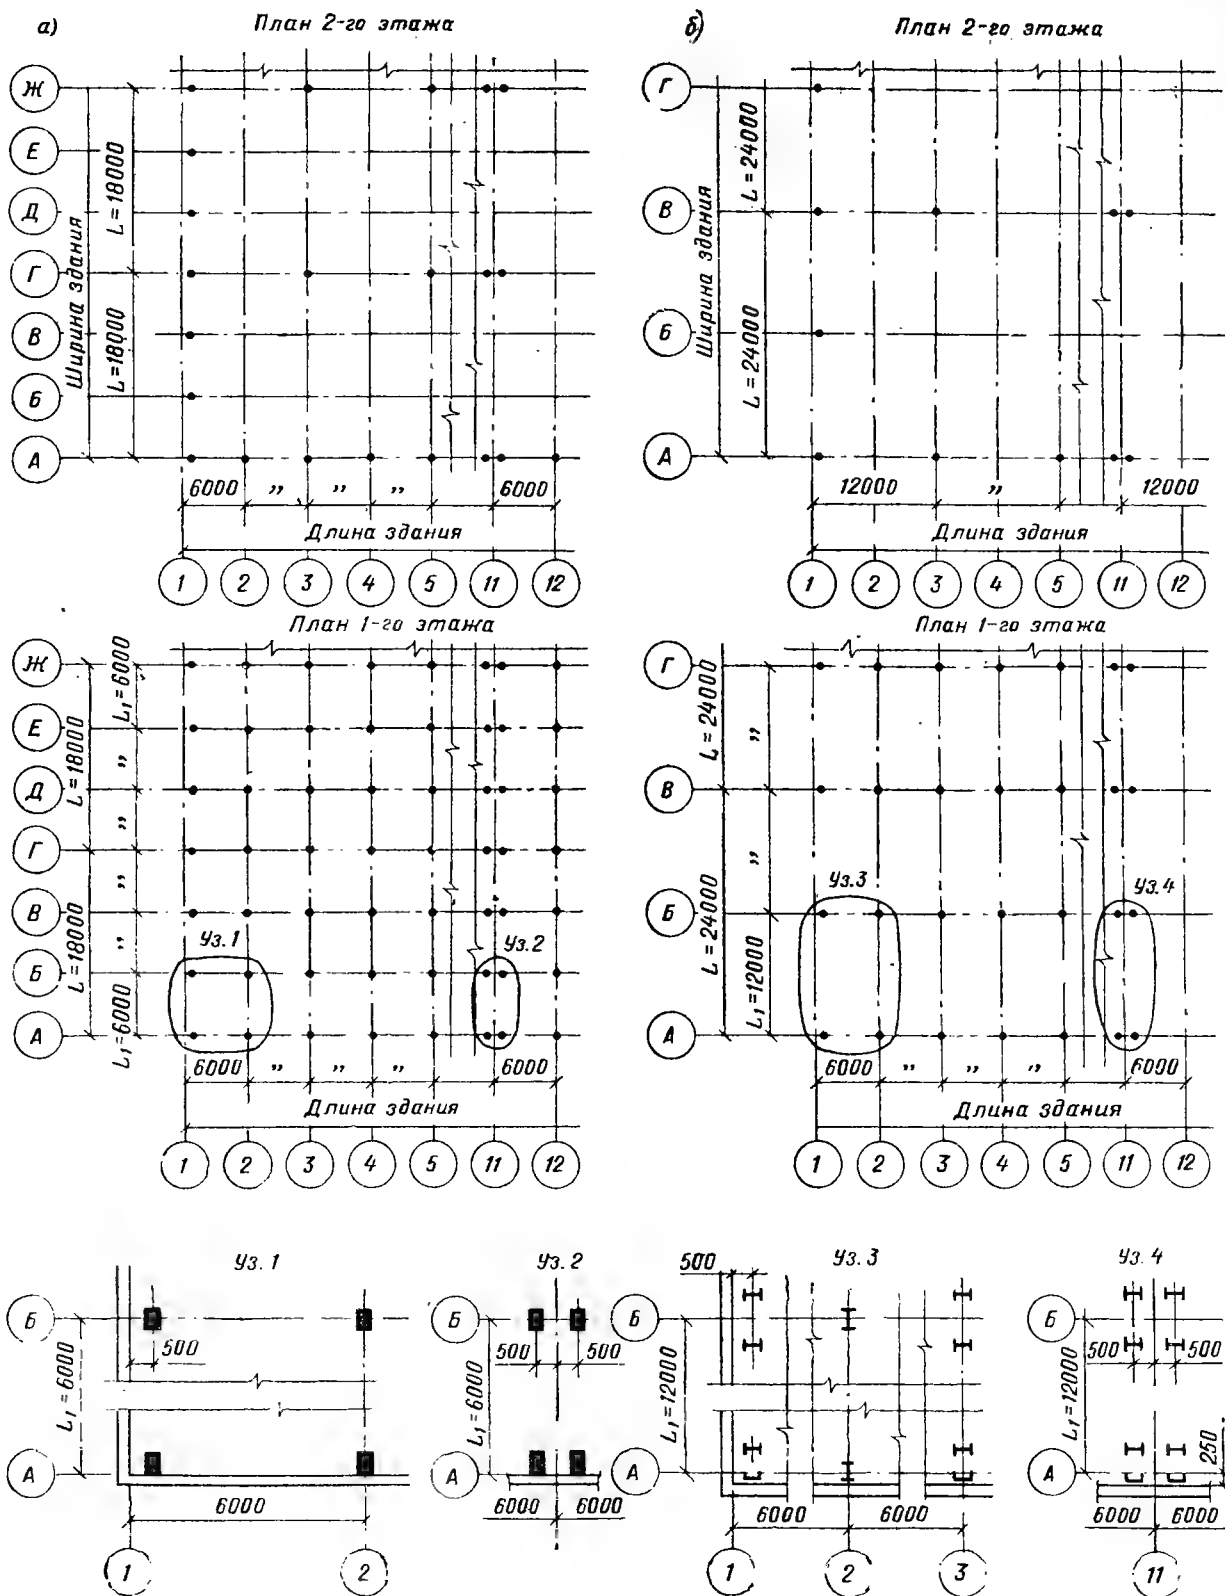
Схематические планы (сетки разбивочных осей) двухэтажных зданий
